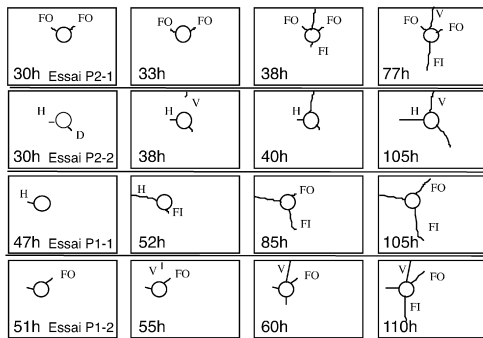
Faciès de fissuration (un essai par ligne).
